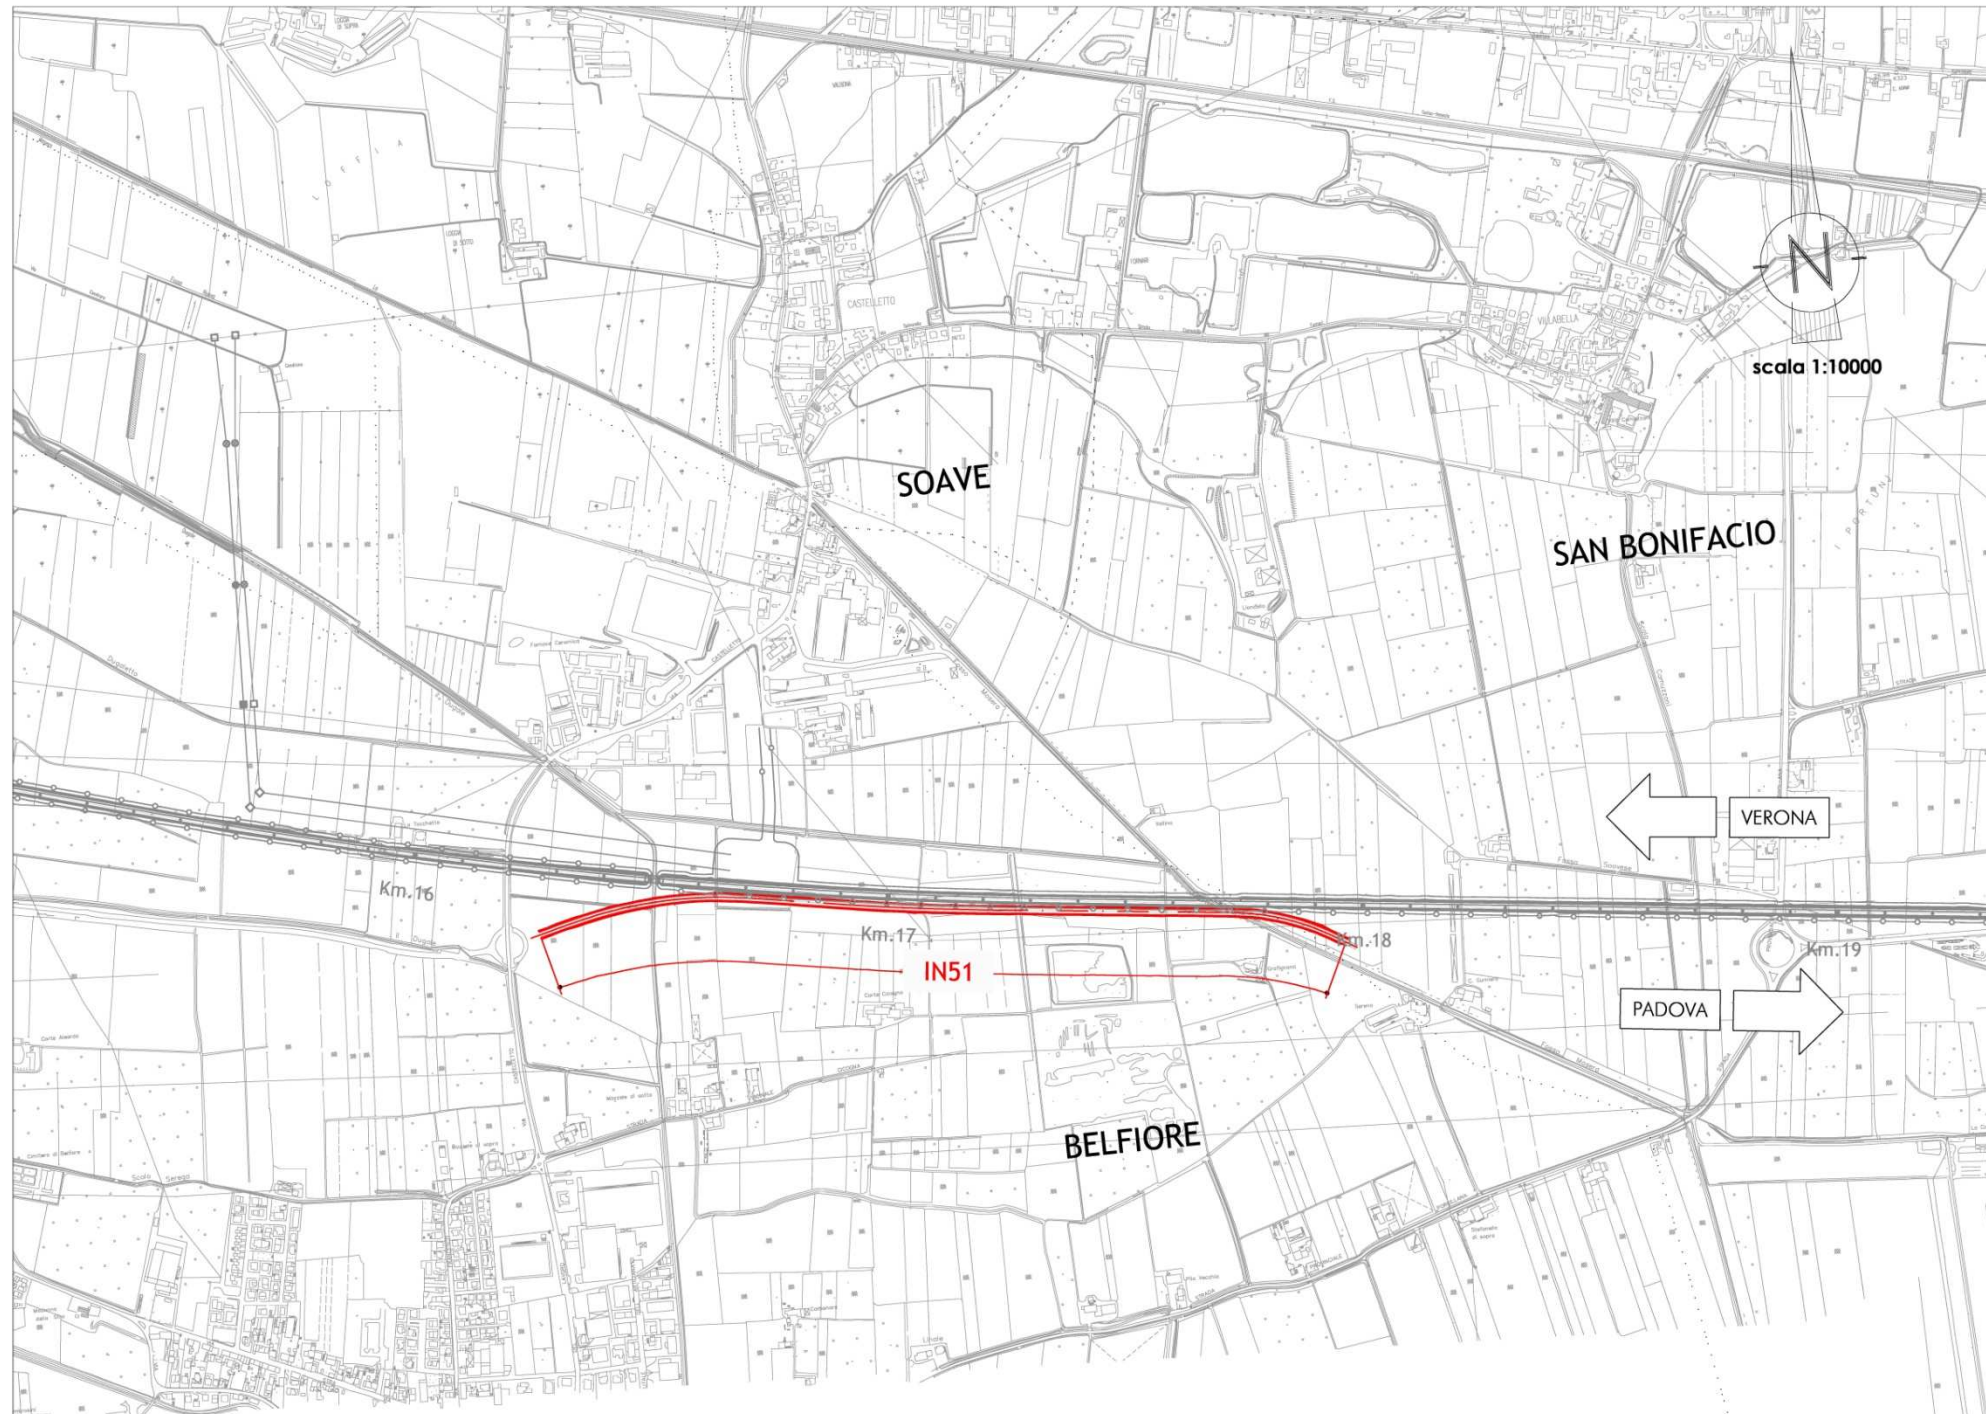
Stralcio planimetrico con individuazione della prima parte della Porcilana, individuata come IN51
